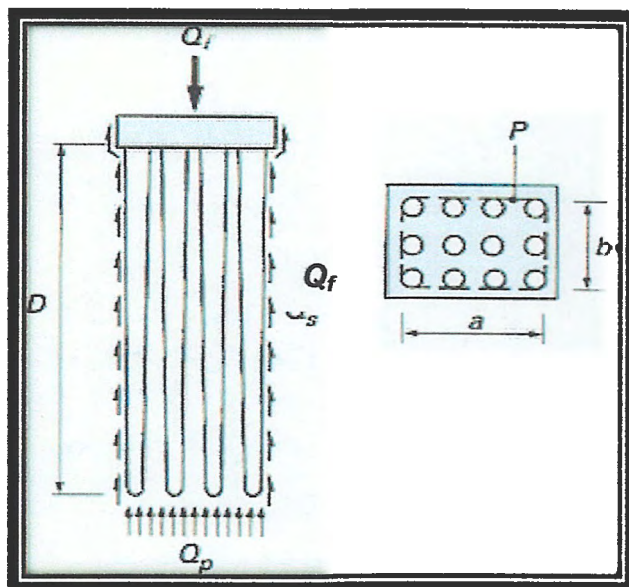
Fondation massive fictive équivalente à un groupe de pieux.
